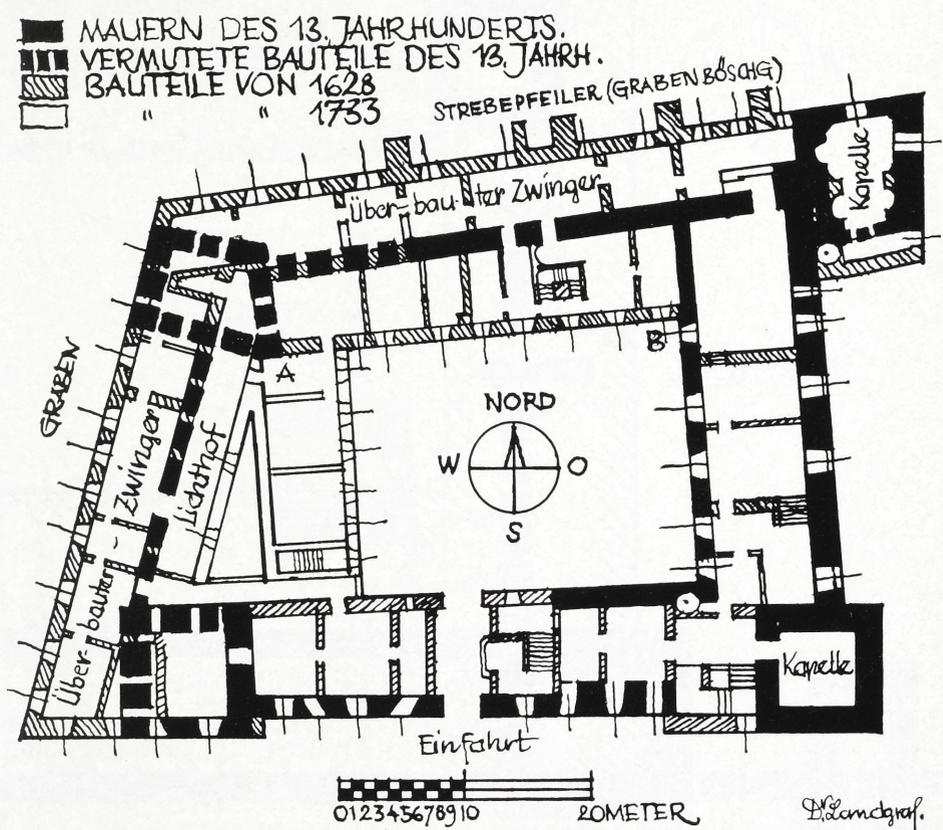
Schloß Marchegg, Grundriß Erdgeschoß, M.1:800
